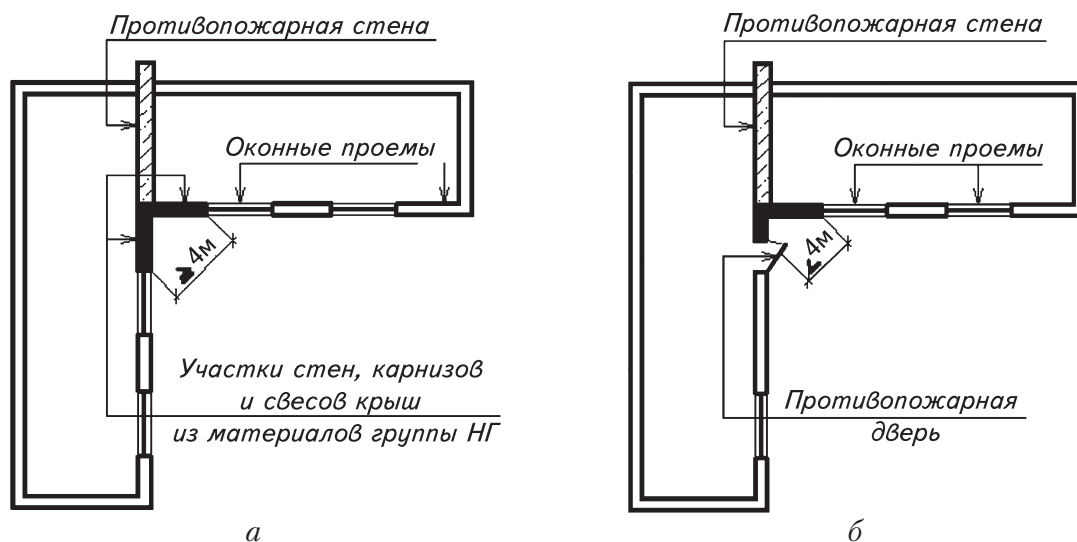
Схема расположения противопожарных стен при примыкании зданий (отсеков) под углом:
